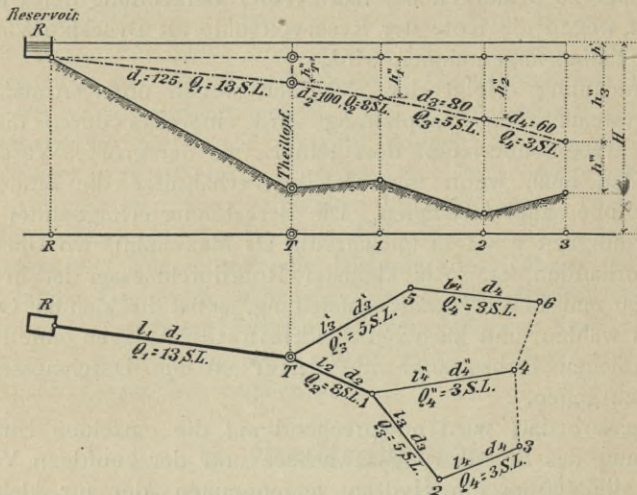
Längenprofil und Situationsplan des Stadtrohrnetzes.
